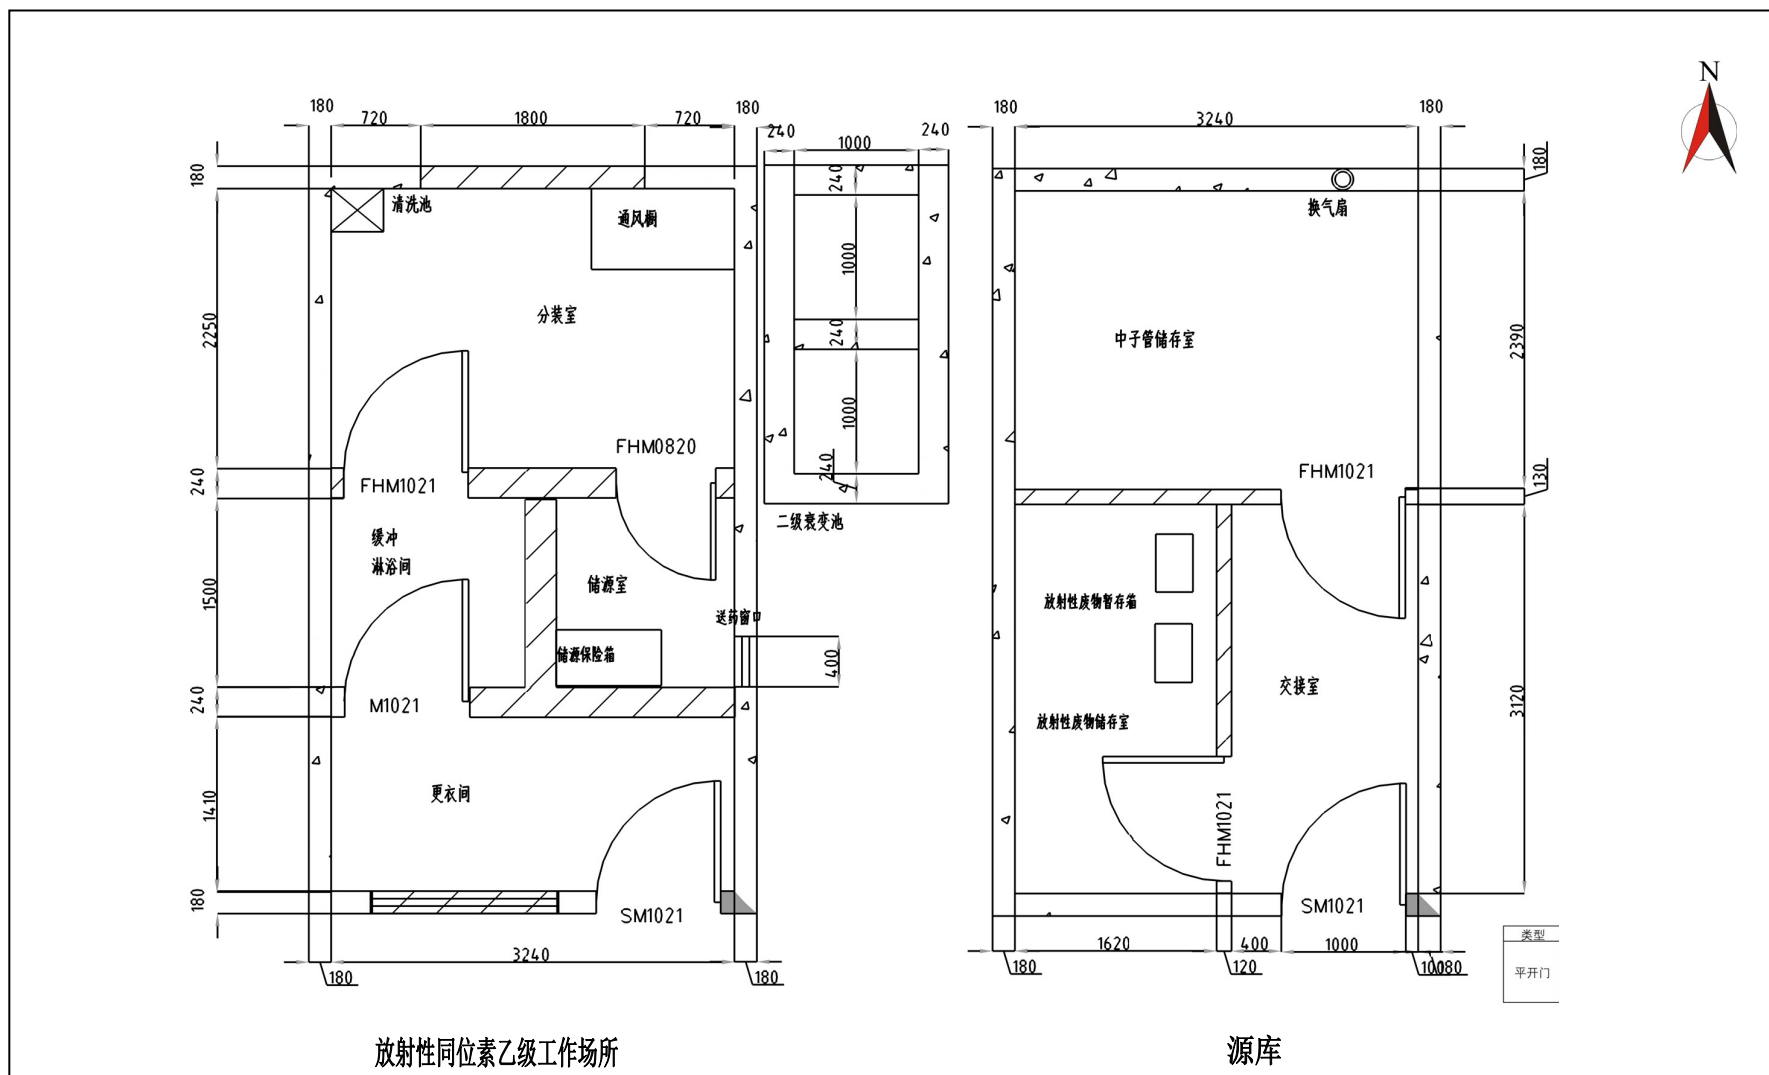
新建源库及放射性同位素工作场所平面布置示意图
